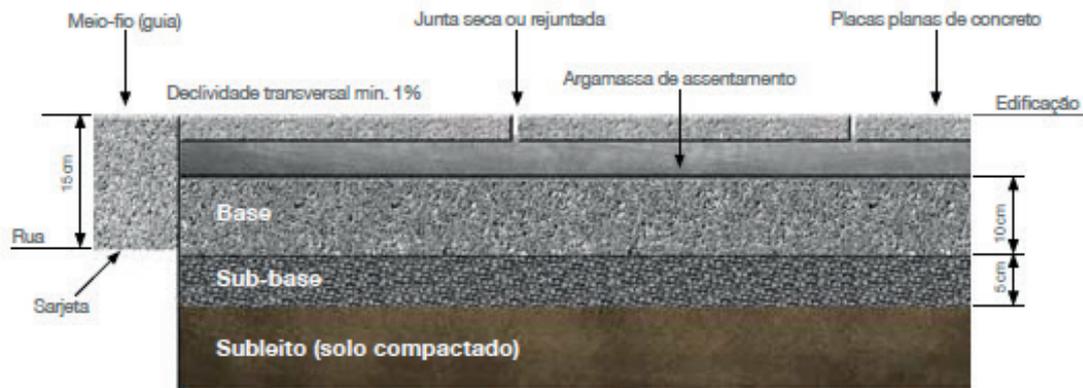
Projeto de passeio usando placas planas de concreto. Fonte: [81]
